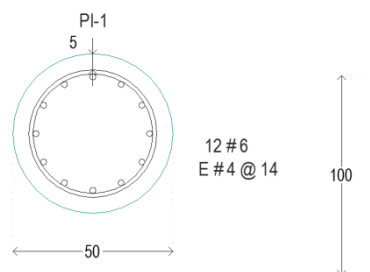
Arreglo de acero en pilas de cimentación para casa de máquinas
